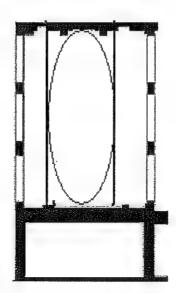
مسقط أفقي لبوابة الخميس، ثقلاً عن Marianne Barrucand, Architecture de la qasba (شكل ٤٧) مسقط أفقي لبوابة الخميس،
